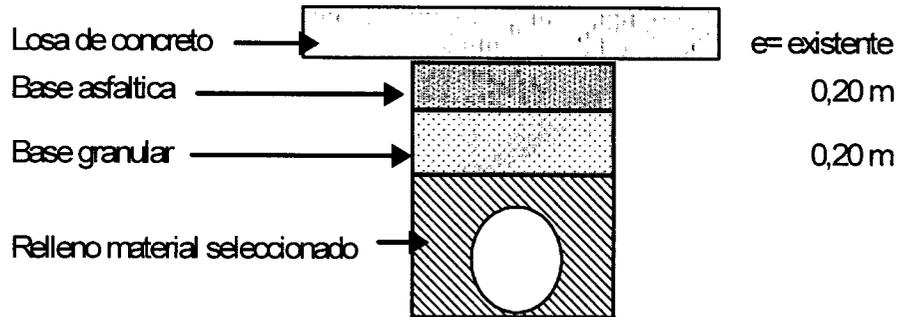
Estructura tipo en Pavimento Rígido para intervenciones en zanja sobre vías arteriales e Intermedias.
